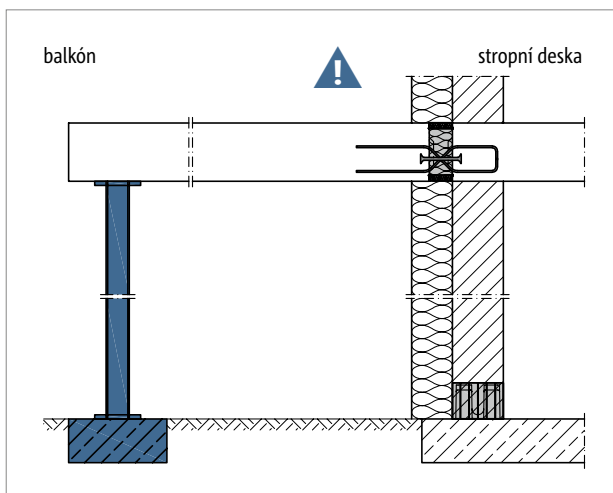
Schöck Isokorb® T typ QLN-VV: Podepření je nutno zajistit i během provádění
